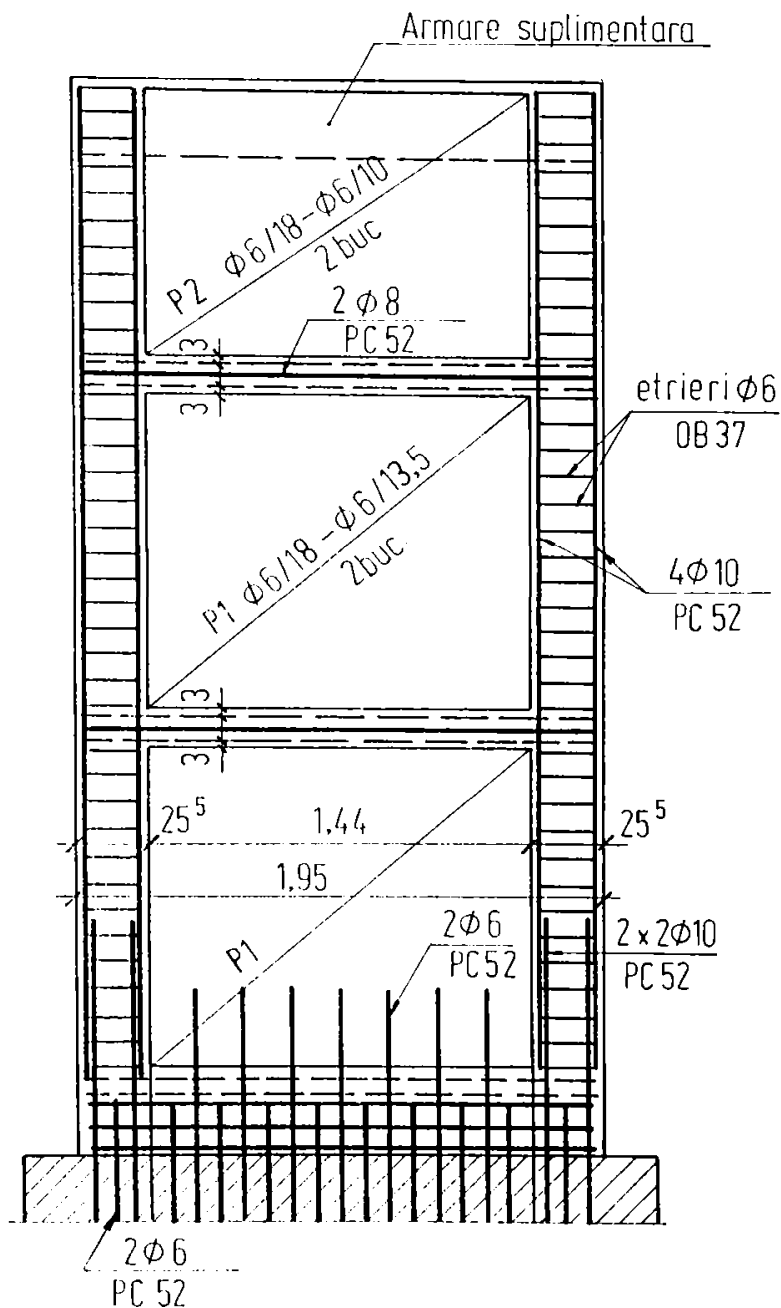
PERETE STRUCTURAL MONOLIT M1 - ARMARE
